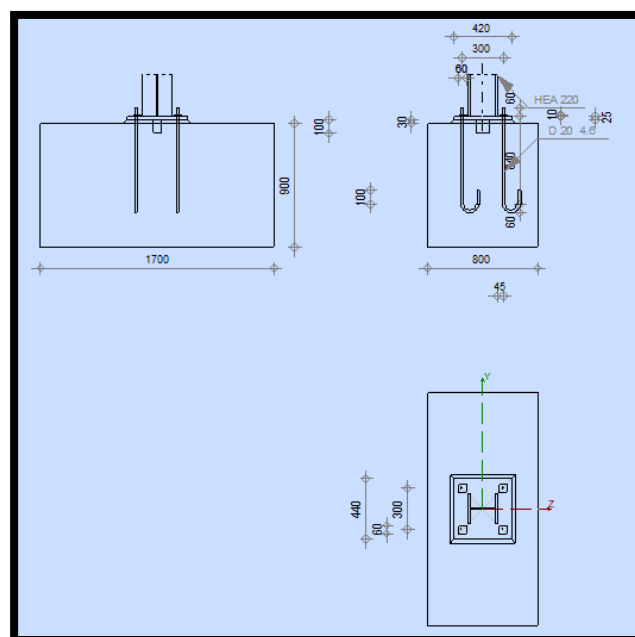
Schéma d'assemblage pied de poteau encastré.
